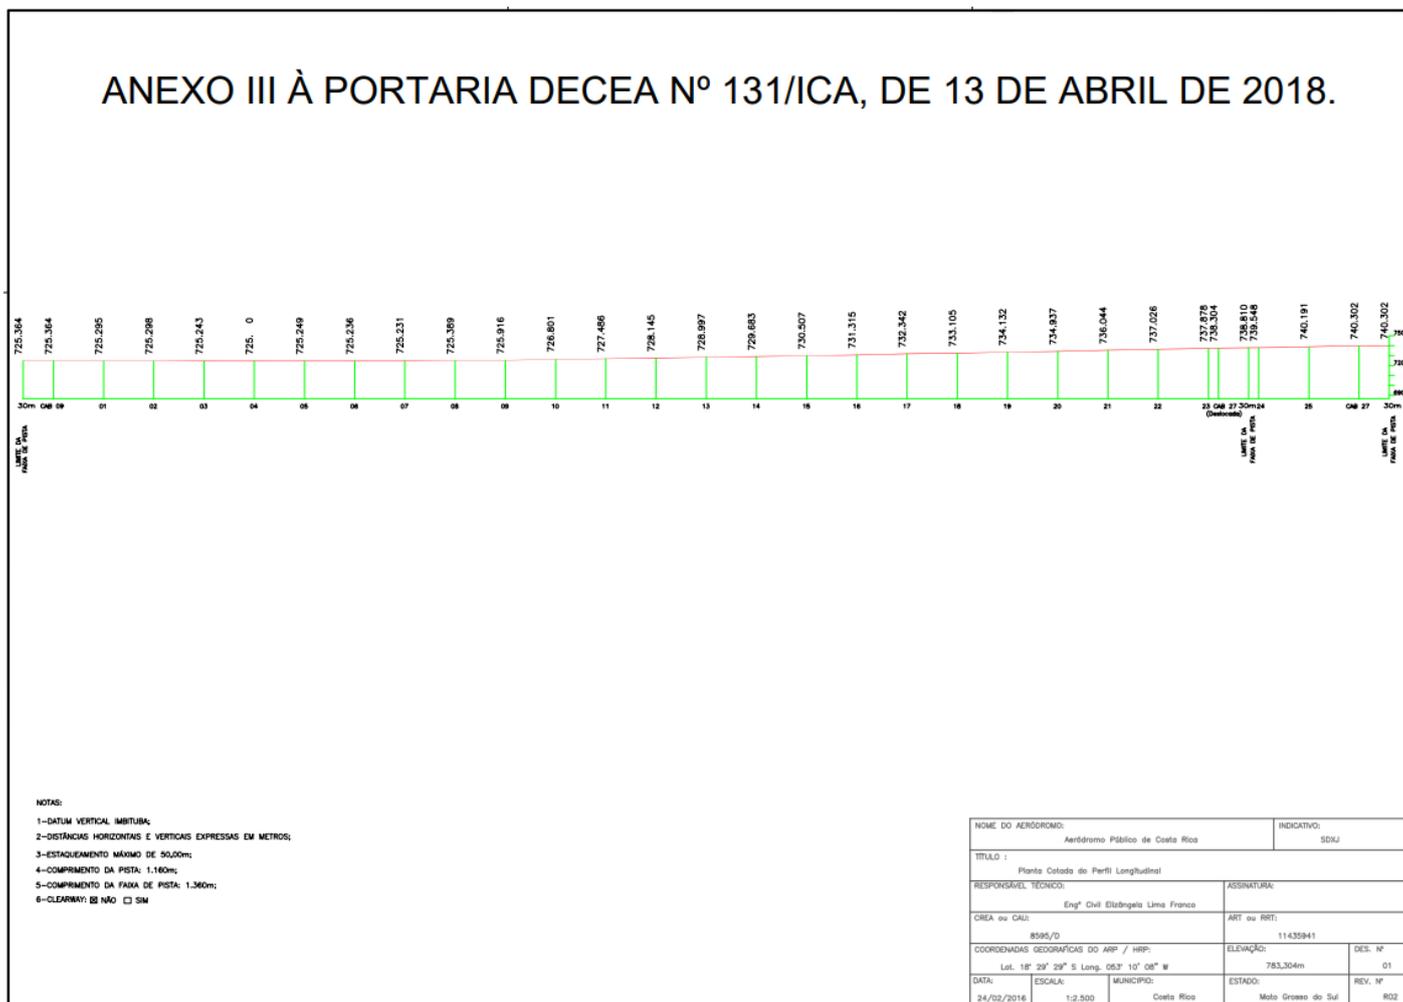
SDXJ: planta de perfis longitudinais da pista de pouso e decolagem
